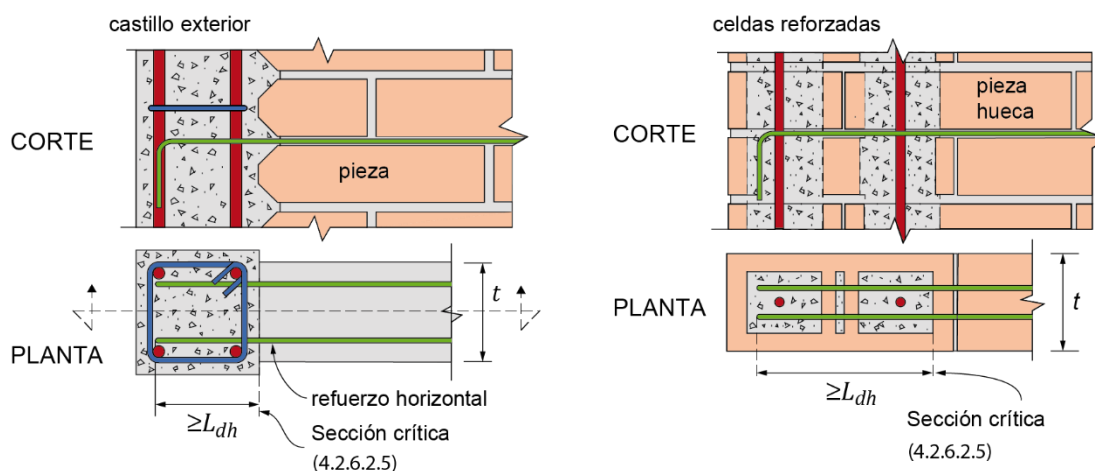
Anclaje de refuerzo horizontal
